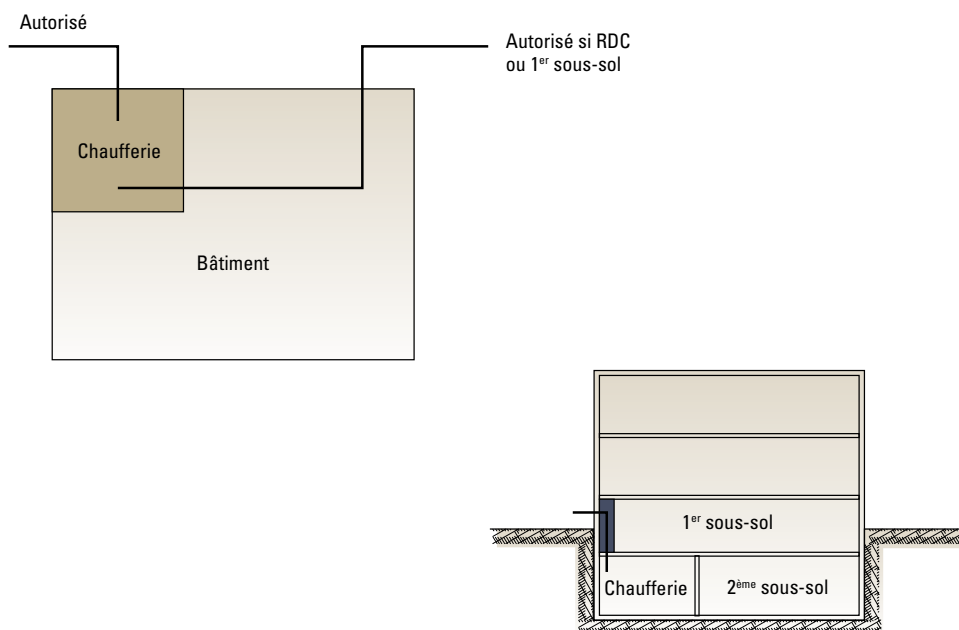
En immeuble existant, la pénétration peut se faire au rez-de-chaussée ou au 1^{er} sous-sol (à gauche) même si la chaufferie est en dessous du premier sous-sol (à droite).
